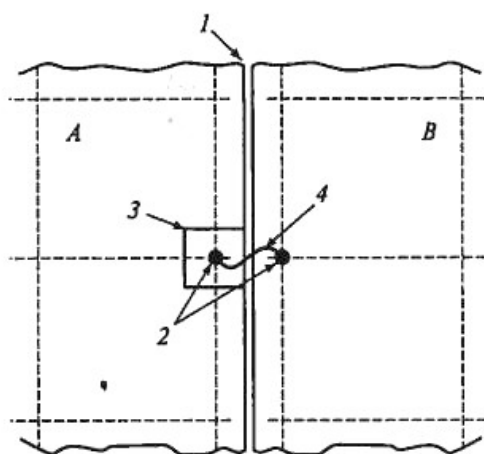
Конструкция гибкой связи между железобетонными плитами:
